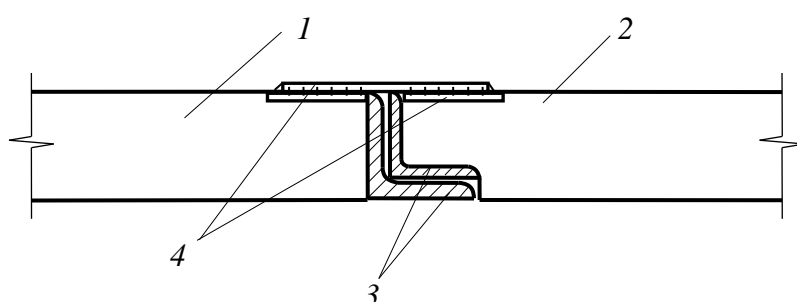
Схема вузла з'єднання плит у збірному сталезалізобетонному безбалковому перекритті:
